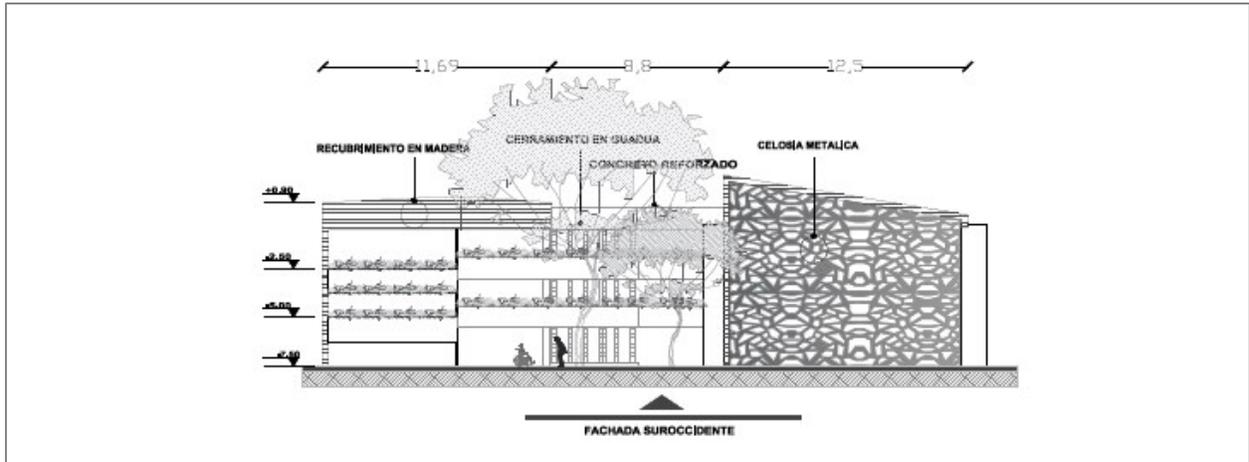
Fachada Suroccidente Edificio 3 (Rubiano, 2020)
